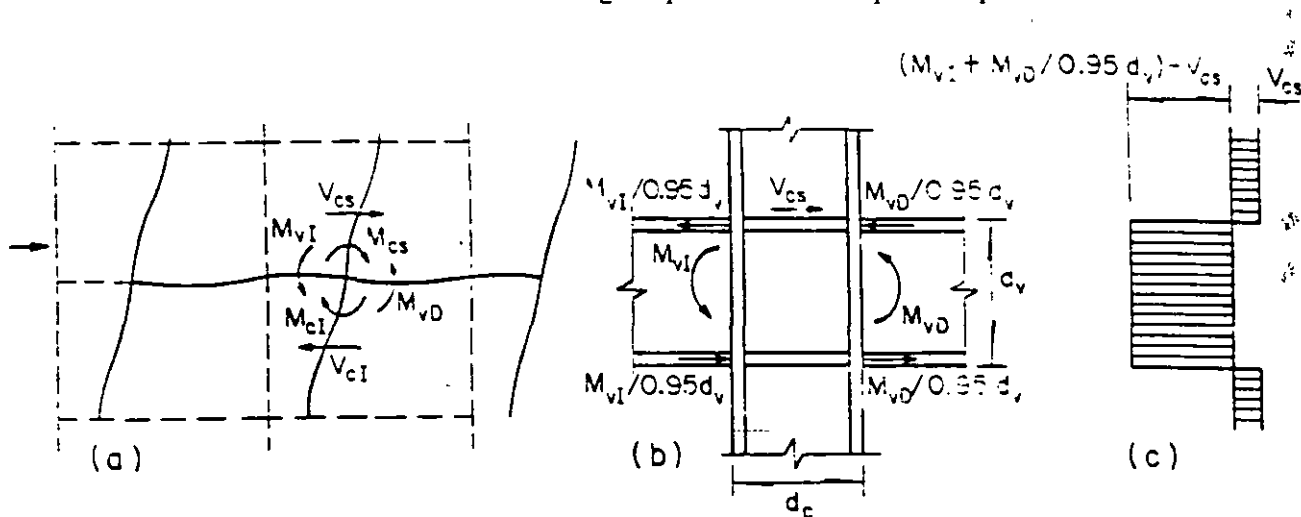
Junta de un marco rígido en el que obran cargas Verticales y horizontales
